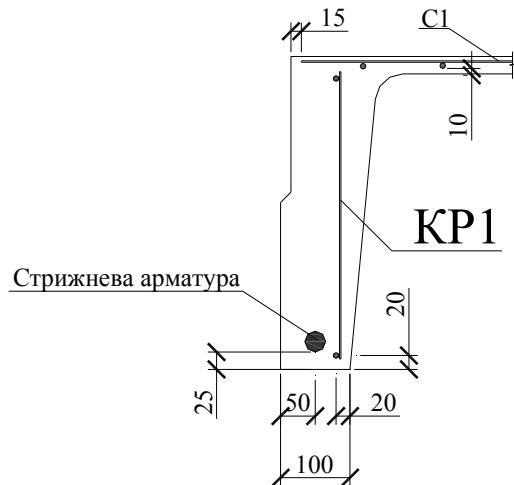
Армування поздовжнього ребра панелі
